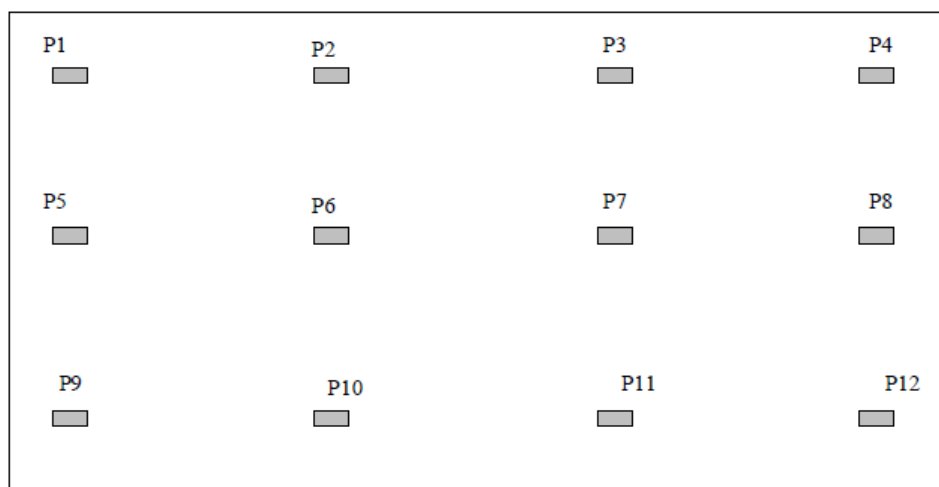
Laje Lisa apoiada diretamente em pilares (LONGO, 2008).
